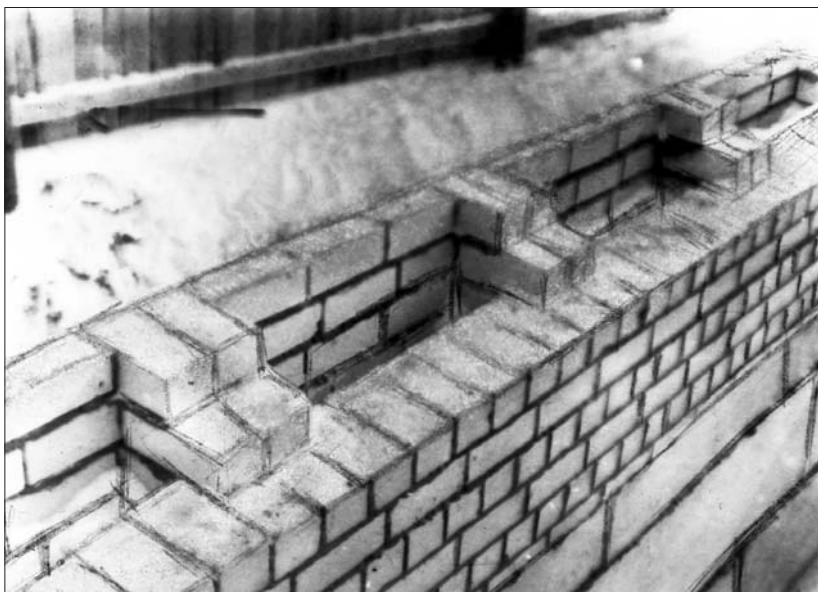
Наружная стена из колодцевой кладки семиэтажного жилого дома в Таллинне (1986 г.). Фото автора
